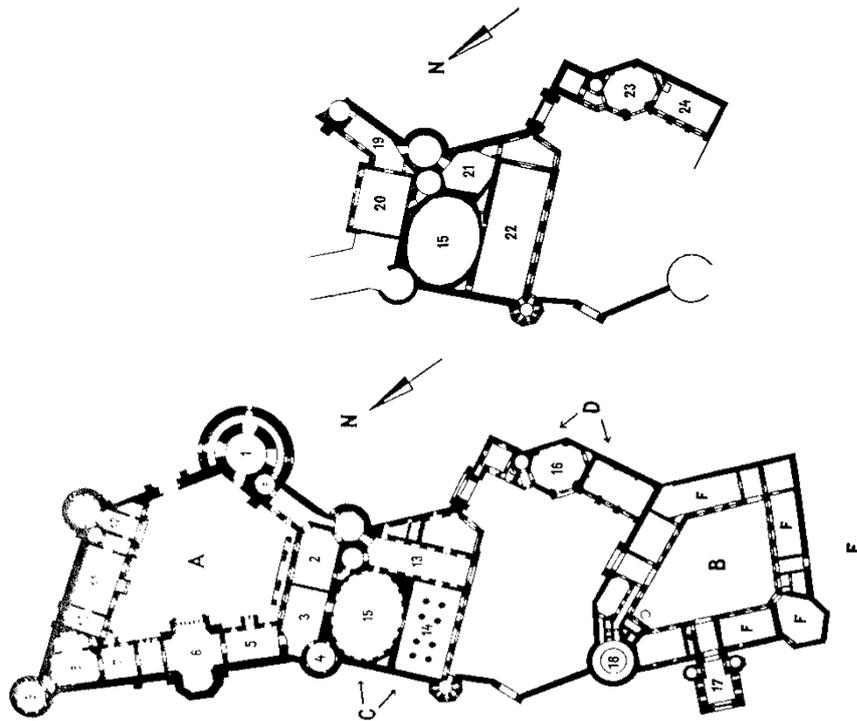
O. A., Grundriss der Franzensburg, Unter- und Obergeschoß.
